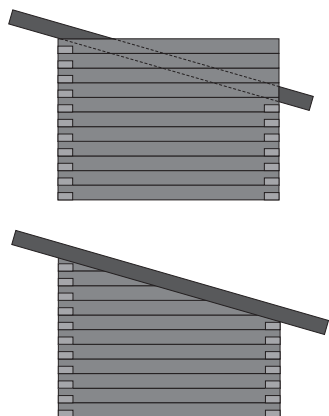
Перекрытие под кровлю с опорой на две несущие стены
